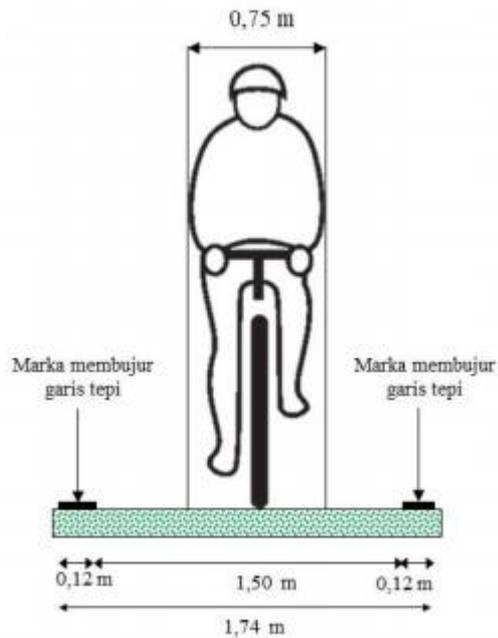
Lebar Minimum Satu Lajur Sepeda
